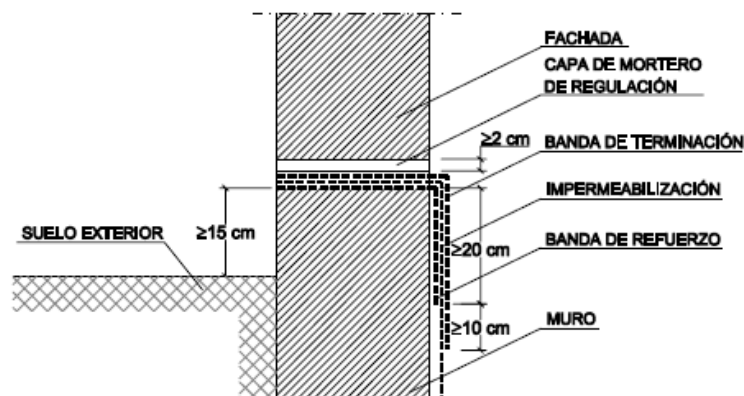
Ejemplo de encuentro de un muro impermeabilizado por el interior con lámina con una fachada
